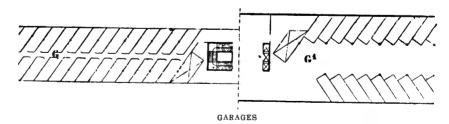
A la izquierda, planta de los garajes que se abren sobre las calles superiores sobre pilares. A la derecha, planta de los garajes situados por debajo del nivel de las calles inferiores. G^1 está conectado con G por un montacargas elevador de vehículos. De G y G^1 , la comunicación es directa con la gran escalera E y el vestíbulo A y, por tanto, con las villas VJ o VS.
